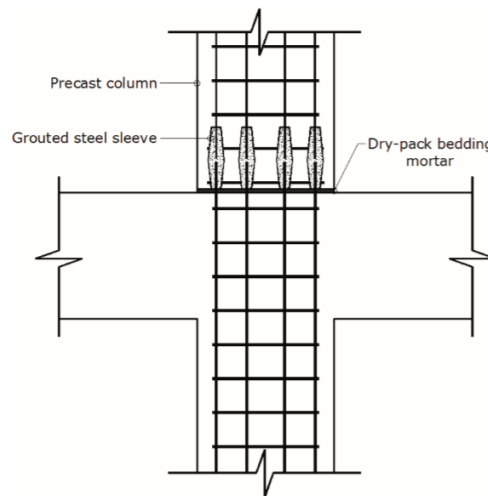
Conexión columna a columna con conector o manga metálica rellenas con una lechada especial. [14]
